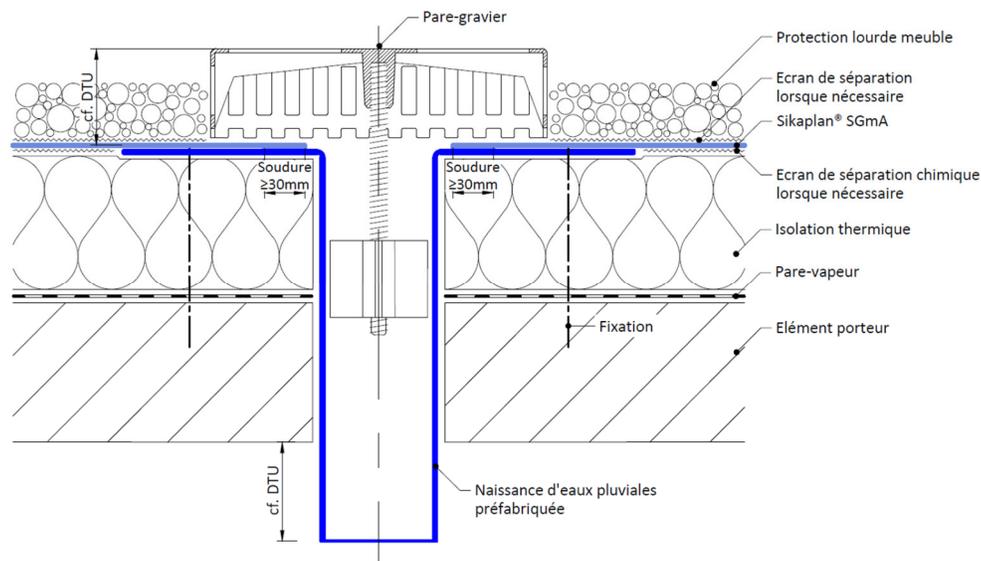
Entrée d'eaux pluviales avec moignon cylindrique préfabriqué en PVC rigide
